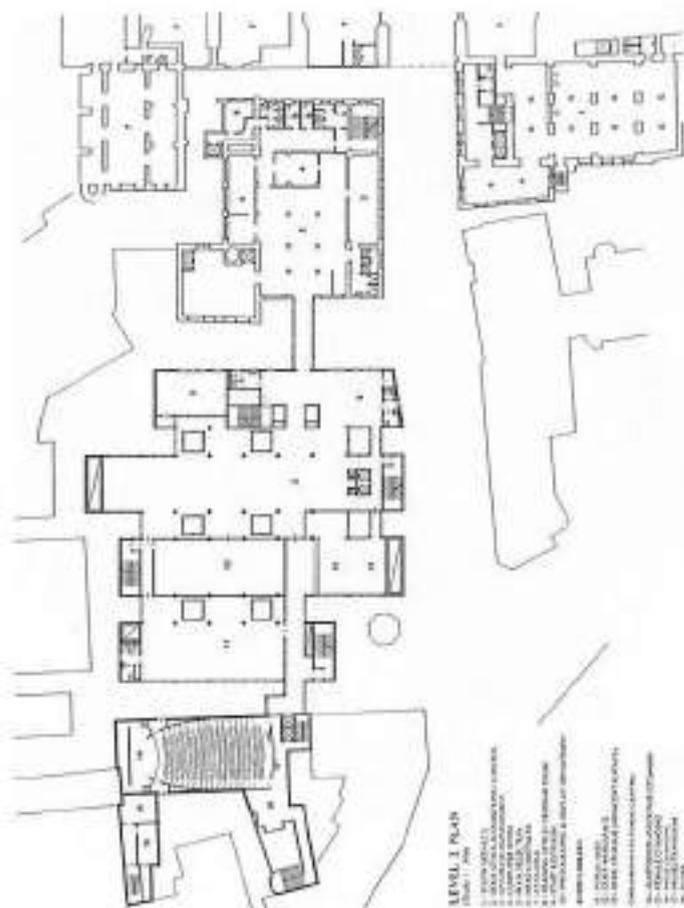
Ampliamento biblioteca centrale di Edimburgo: pianta piano secondo.
